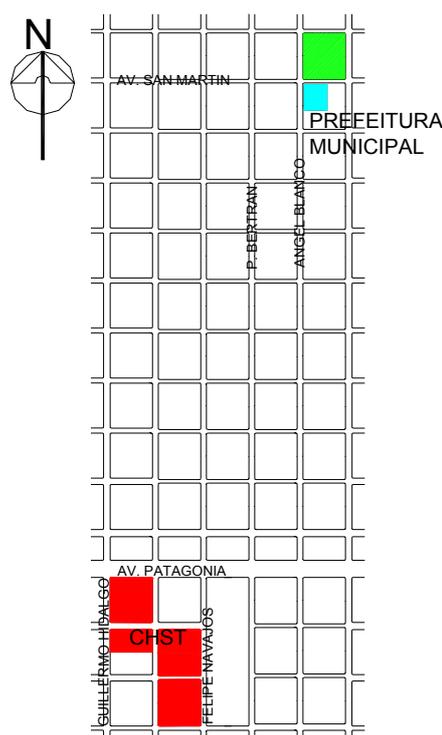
Planta de situação do Conjunto Habitacional Santo Tomé - CHST
